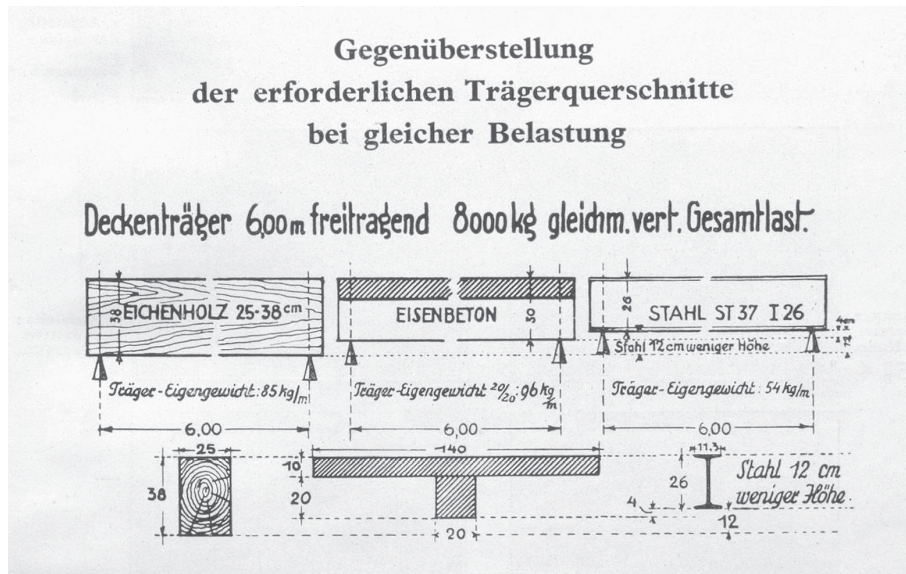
Vergleichende Darstellung von Trägern aus Holz, Eisenbeton und Stahl als Werbemittel der Stahlindustrie.
